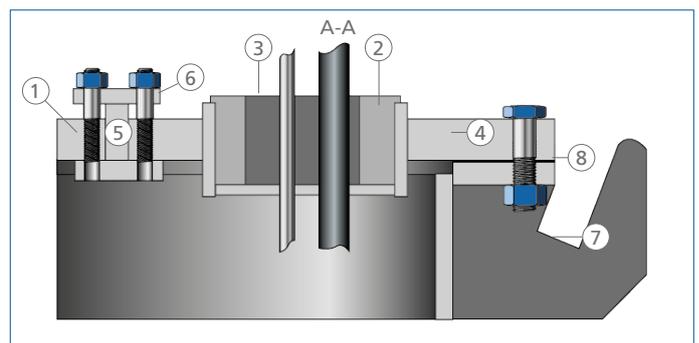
Ausführungsvariante mit Stopfrahmen (bis 1 bar)
